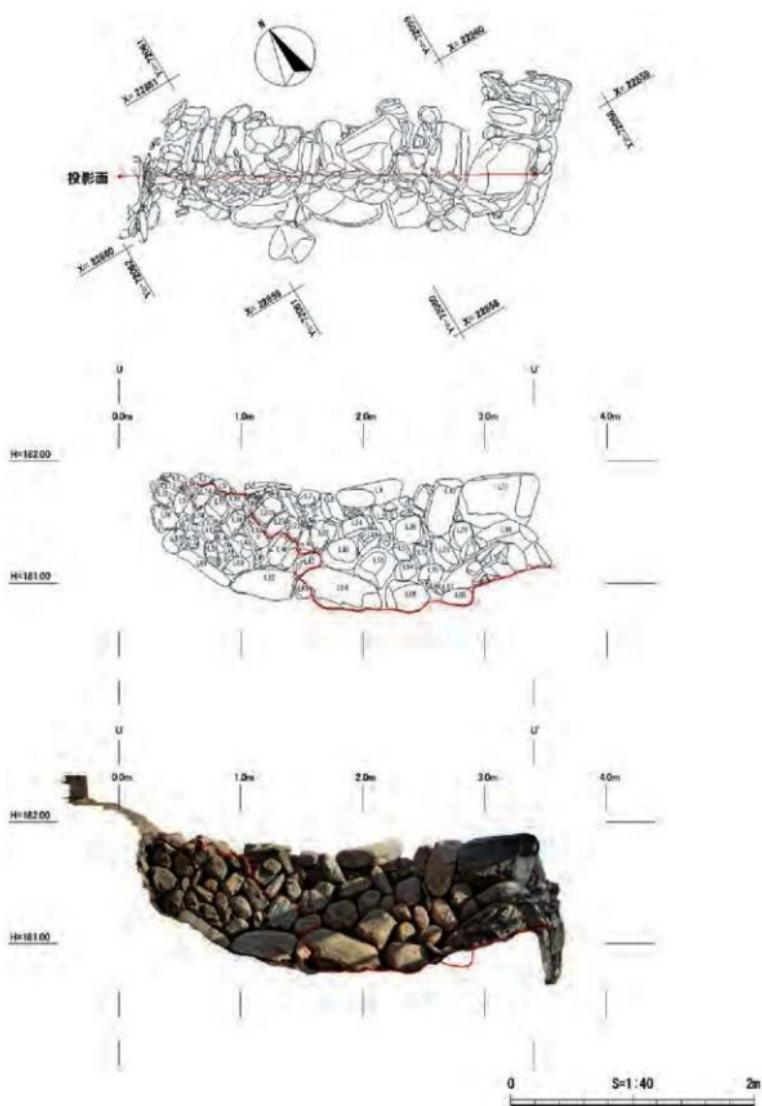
石垣 B 平面・立面図・オルソ画像
